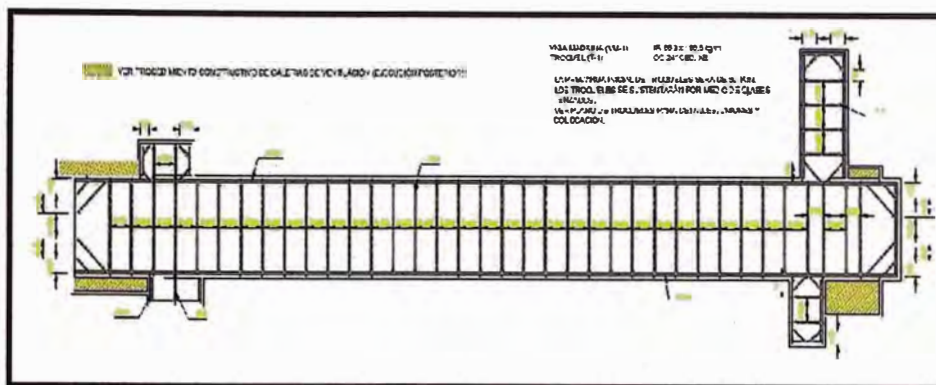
Vista en planta de la estación Mexicaltzingo.
